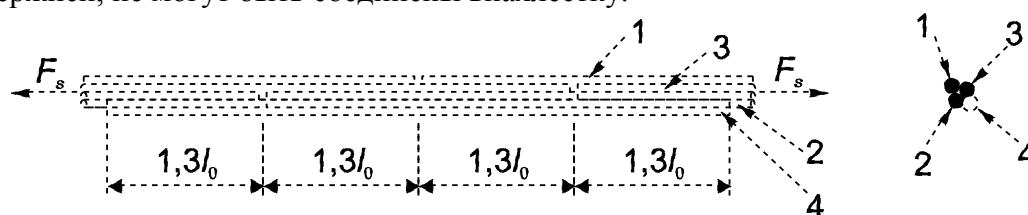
Соединение внахлестку при растяжении с применением четвертого стержня (соединительной накладки)
